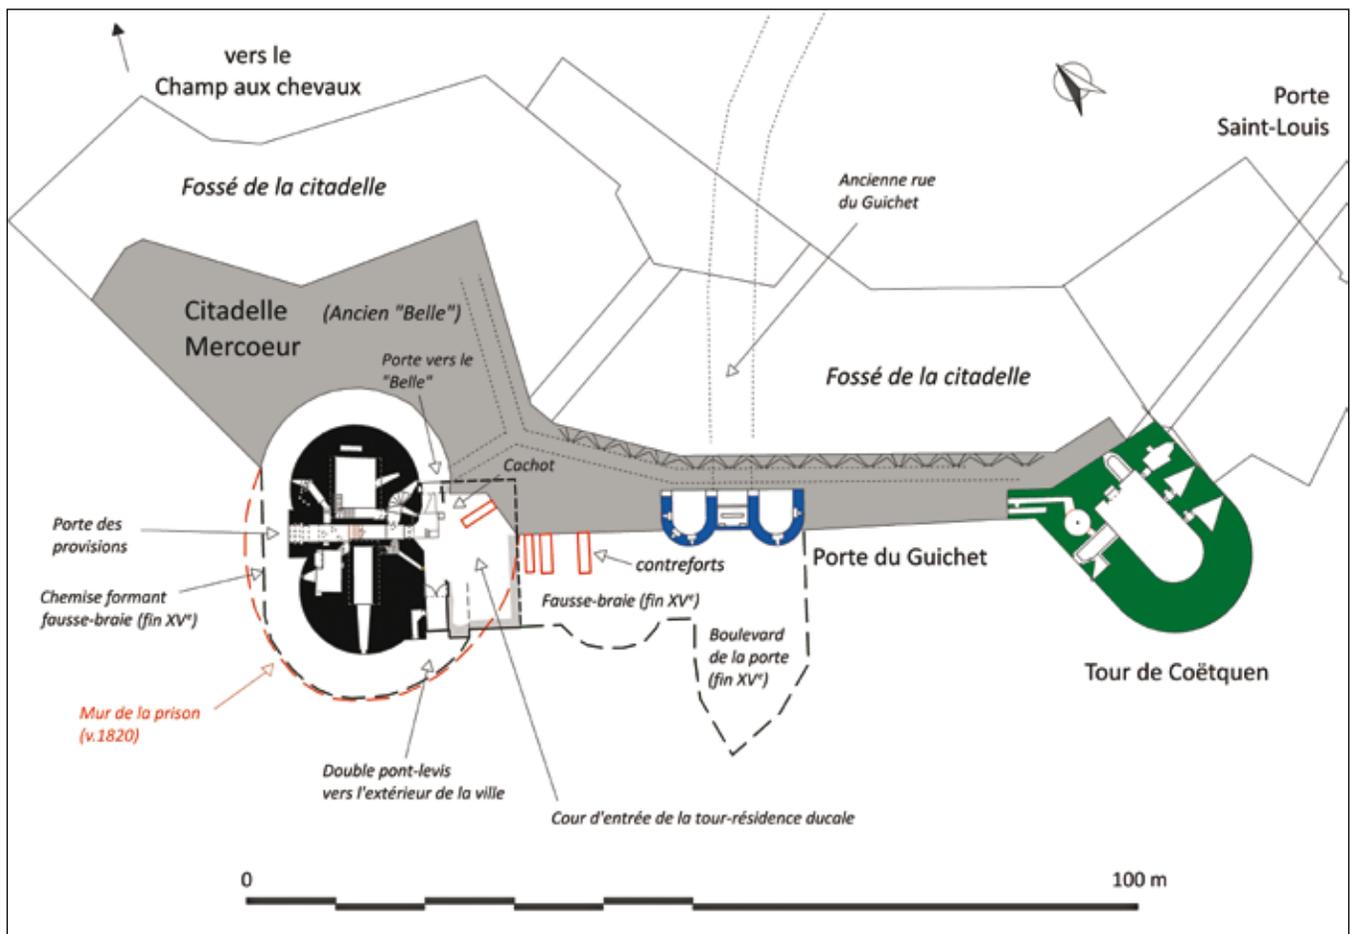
Dinan, plan de la citadelle avec figuration en pointillés des éléments aujourd'hui disparus : en noir, murs détruits au début du XIX^e siècle ; en rouge, murs de la prison construits en 1820, détruits en 1906 (dessin J. Mesqui, 2015).
